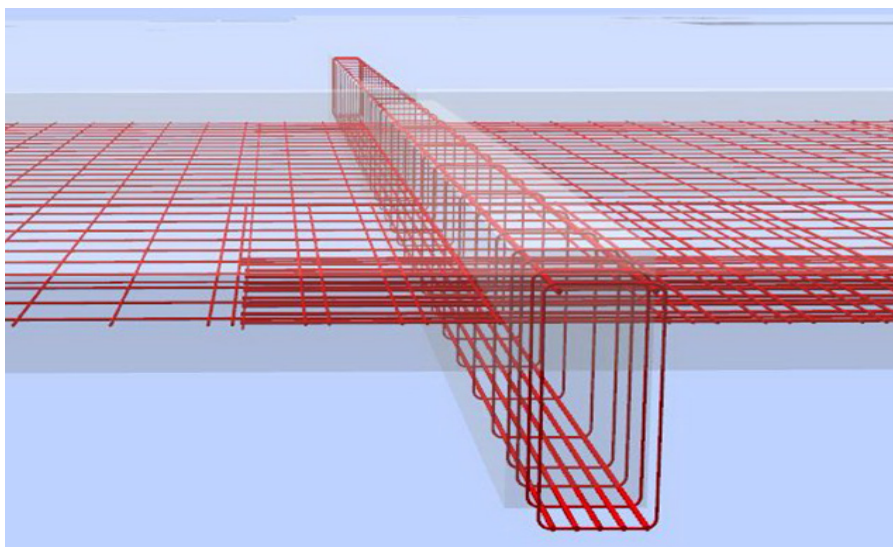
Укладка первого и второго слоёв нижней сетки армирования
